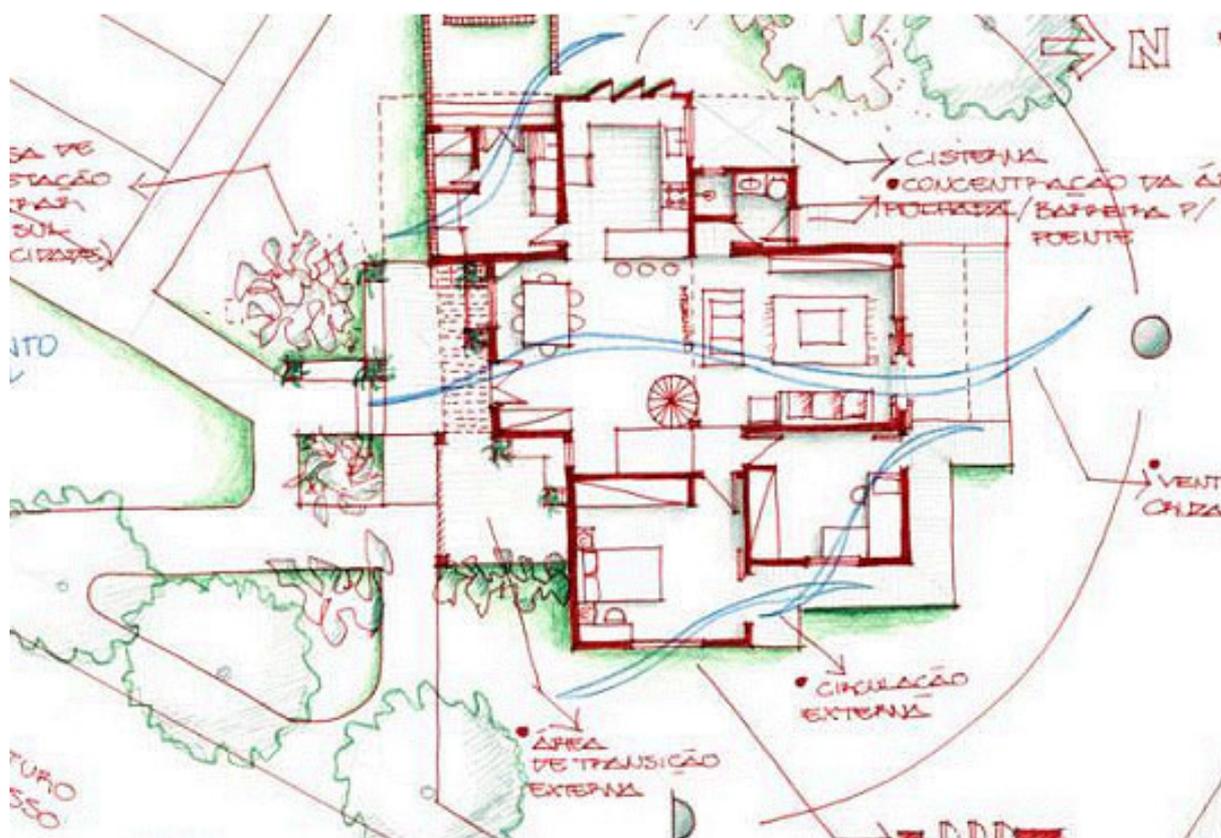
Planta esquemática da Casa Eficiente.
